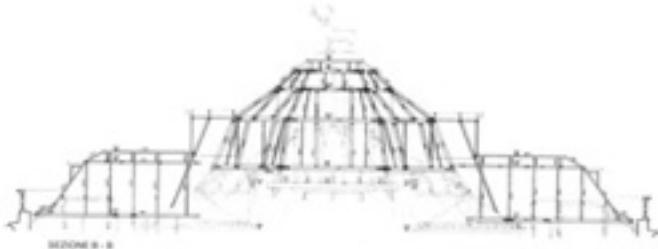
Stupinigi. Fondazione Palazzina Mauriziana di Stupinigi. Salone centrale e appartamenti Reali. sezione longitudinale
